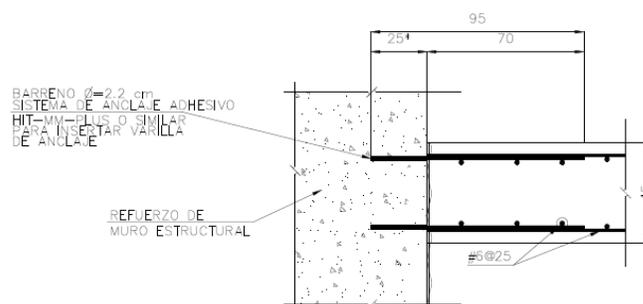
Detalle 1. Detalle de refuerzo horizontal de trabes de media caña.
